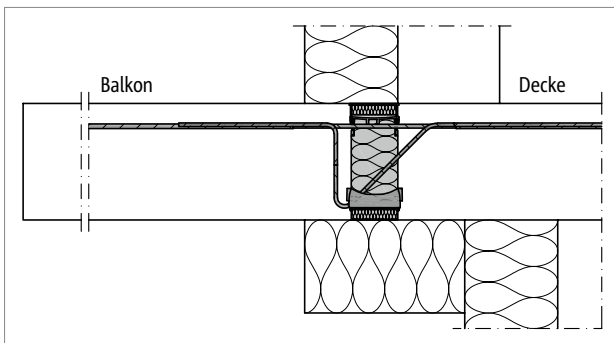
Schöck Isokorb® T Typ KL: Anschluss bei indirekt gelagerter Decke und WDVS
